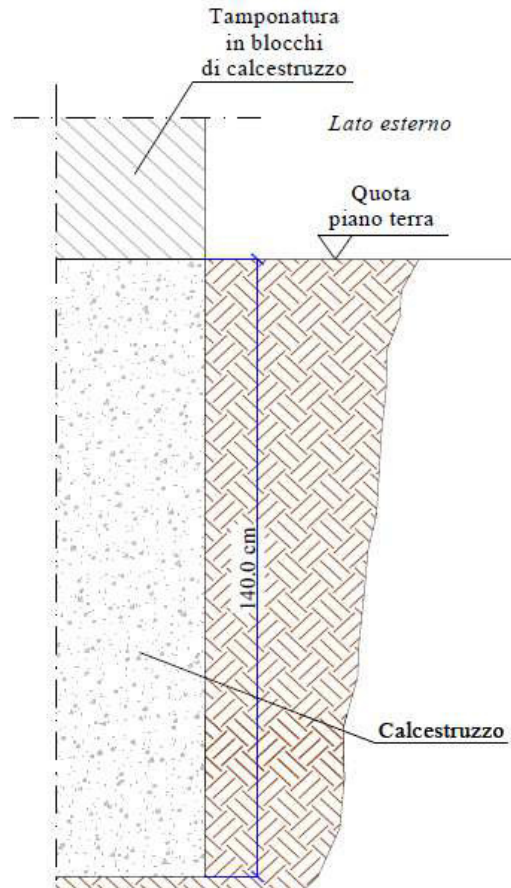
Tipologia di fondazioni individuate Corpo B (SF2 - Saggio in fondazione).
